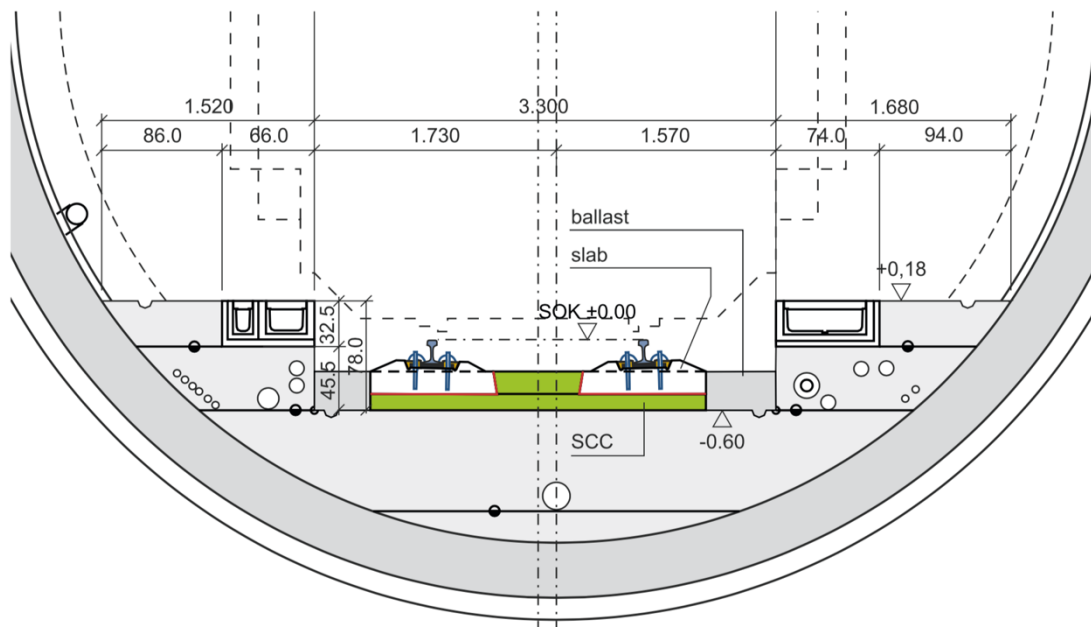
Pokládání prefabrikovaných panelů ÖBB-Porr [9]
